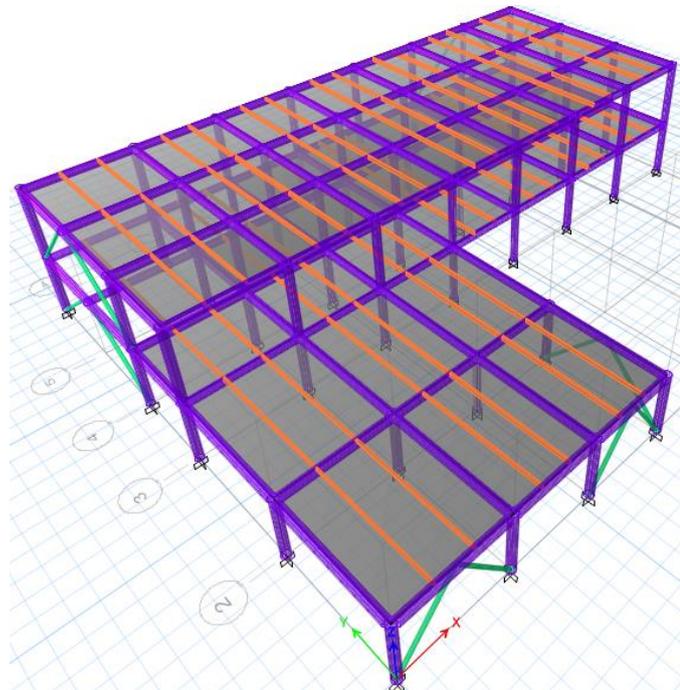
34. Propuesta de reforzamiento planteada para la estructura existente.
